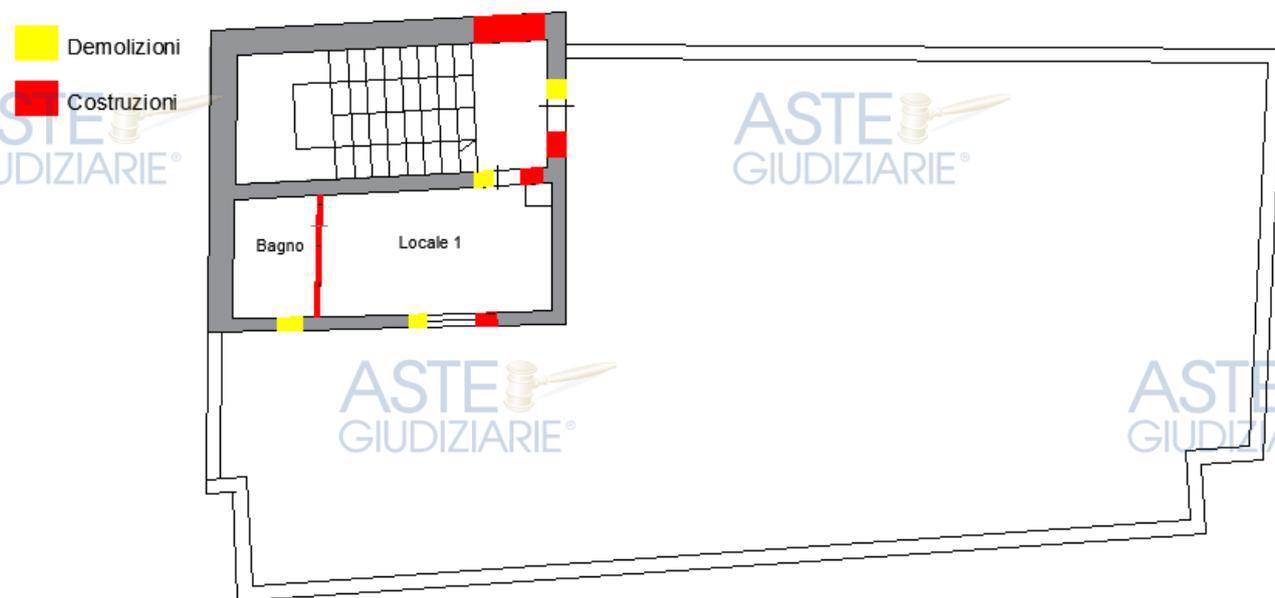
Confronto catastale - pianta piano terzo del sub.13
